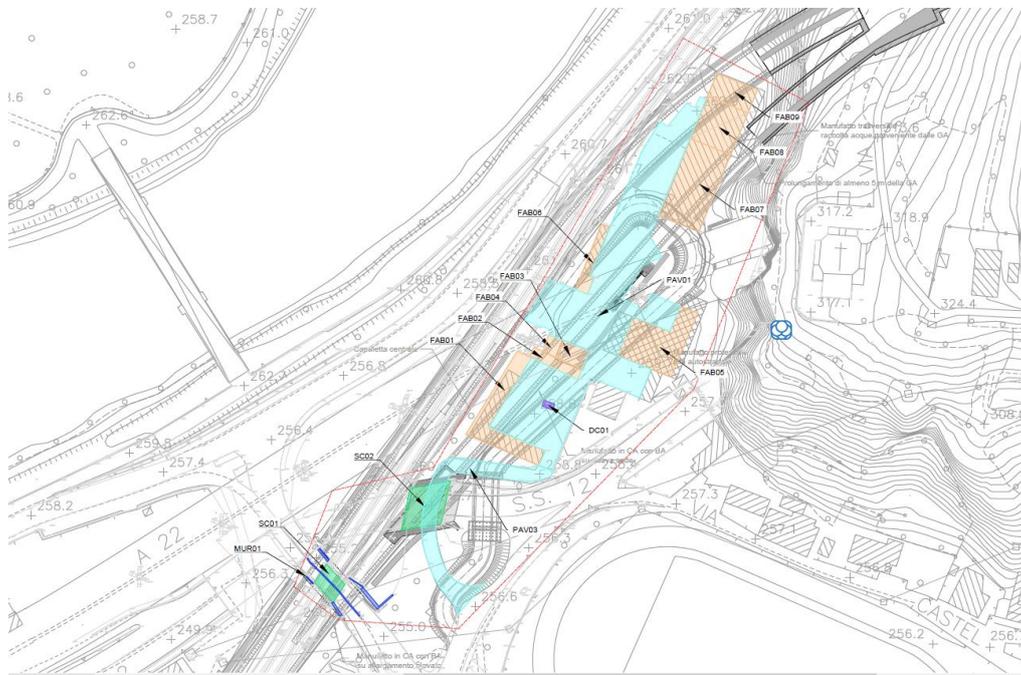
estratto planimetria delle demolizioni (giallo la demolizione di fabbricati – celeste demolizione del piano stradale)
